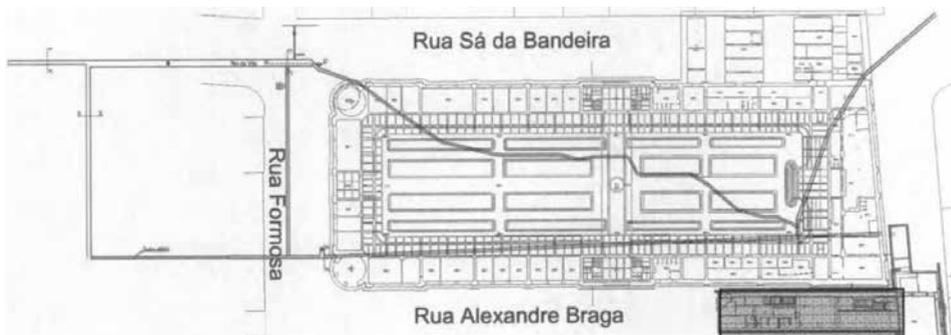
Galerias subterrâneas existentes na área de implantação do Mercado do Bolhão.
